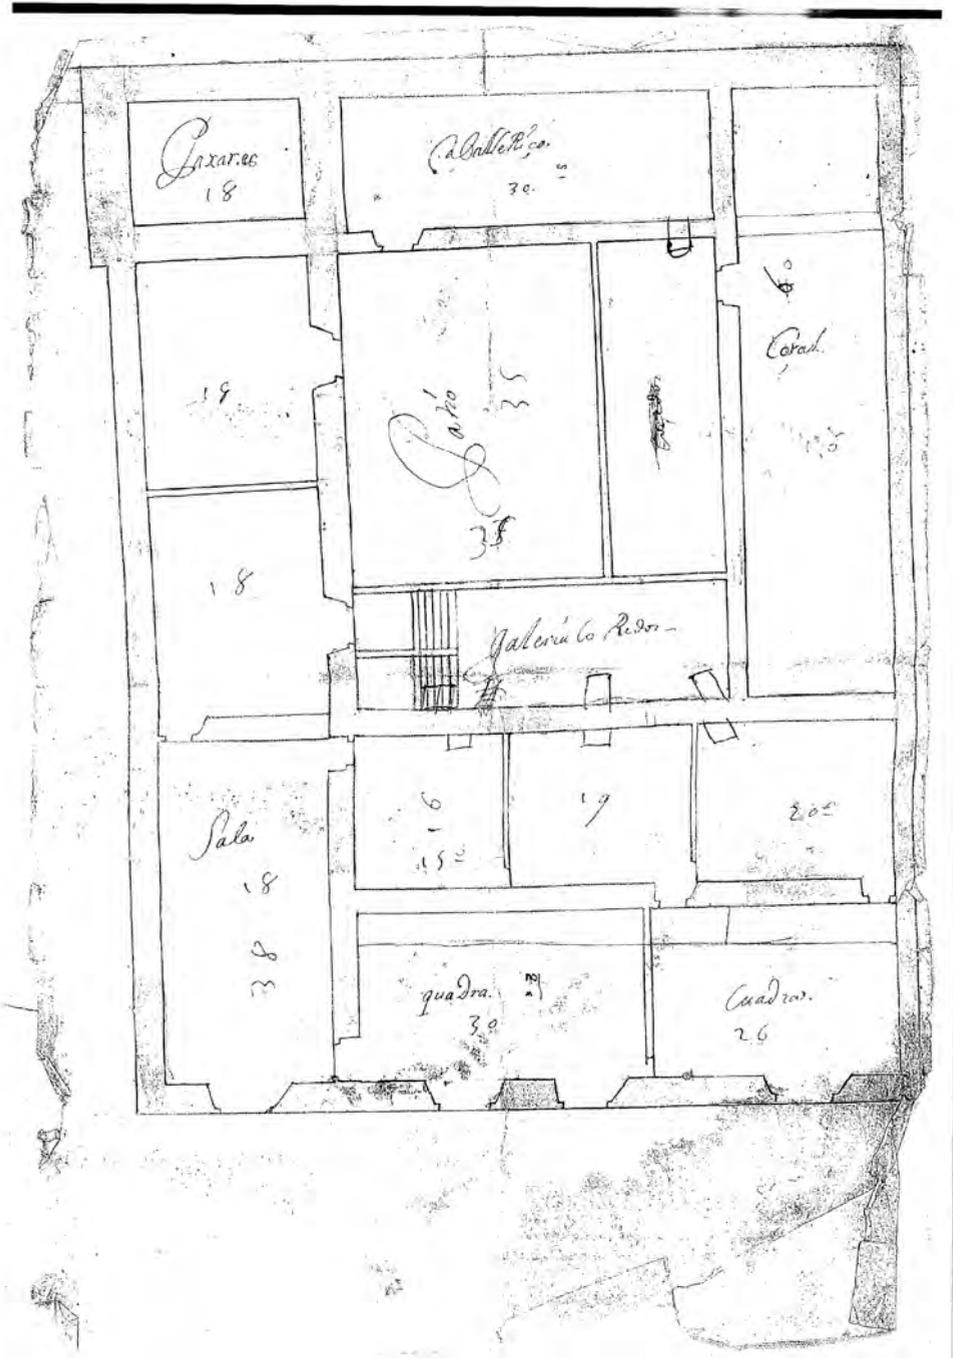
Palacio de Buenavista - Plano de la planta baja del palacio [AHPZ: Híjar, 4ª-276-1].
